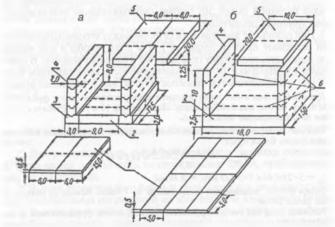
Разбивка конструктивных блоков на строительные: 1 - понурная плита; 2 - фундаментная плита; 3 - фундамент бычка; 4 - бычок; 5 водобойная плита; 6 - строительные швы.
